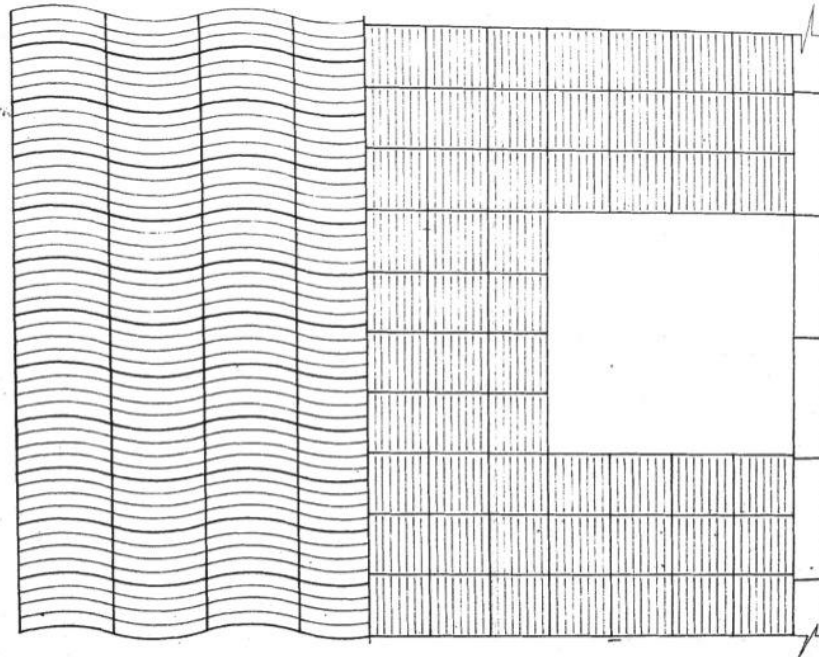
> Plano proyecto pavimentación rambla Sta Monica (AMCB. 1978) Materiales: (1) losas vibrado relieve de 60x40x3,5 cm. de lados curvos color beige claro y (2) beige oscuro para la parte central, y (3) losas vibrado relieve de 40x40x3,5 cm. de lados rectos color gris oscuro
